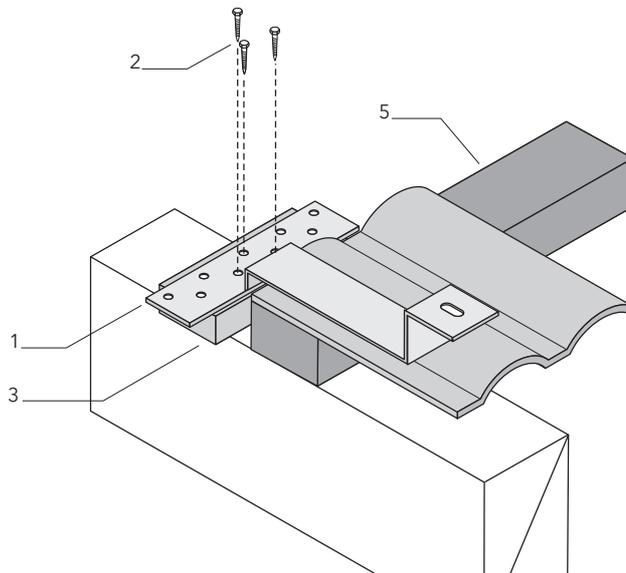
Montage des Sparrenankers (1) Sparrenanker; (2) Schnellbauschrauben; (3) Holzunterlage; (5) Dachlatte; Wenn die Dachlatte höher ist als 30 mm, dann muss der Anker mit Holz (3) entsprechender Dicke unterfüttert werden.
